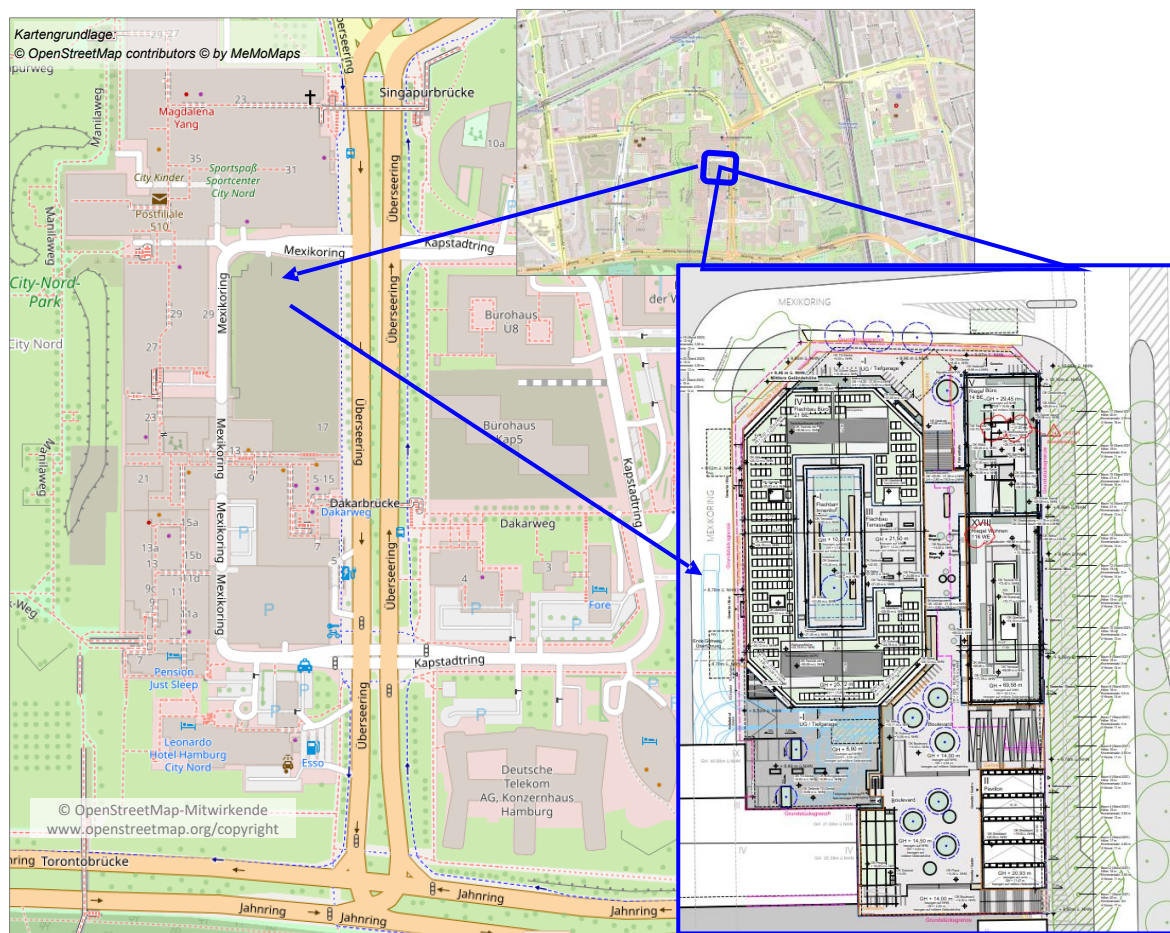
Übersichtslageplan (o.M., Quelle: © OpenStreetMap-Mitwirkende, [www.openstreetmap.org/copyright](http://www.openstreetmap.org/copyright), Lageplan blrm Architekt\*innen GmbH [1])
